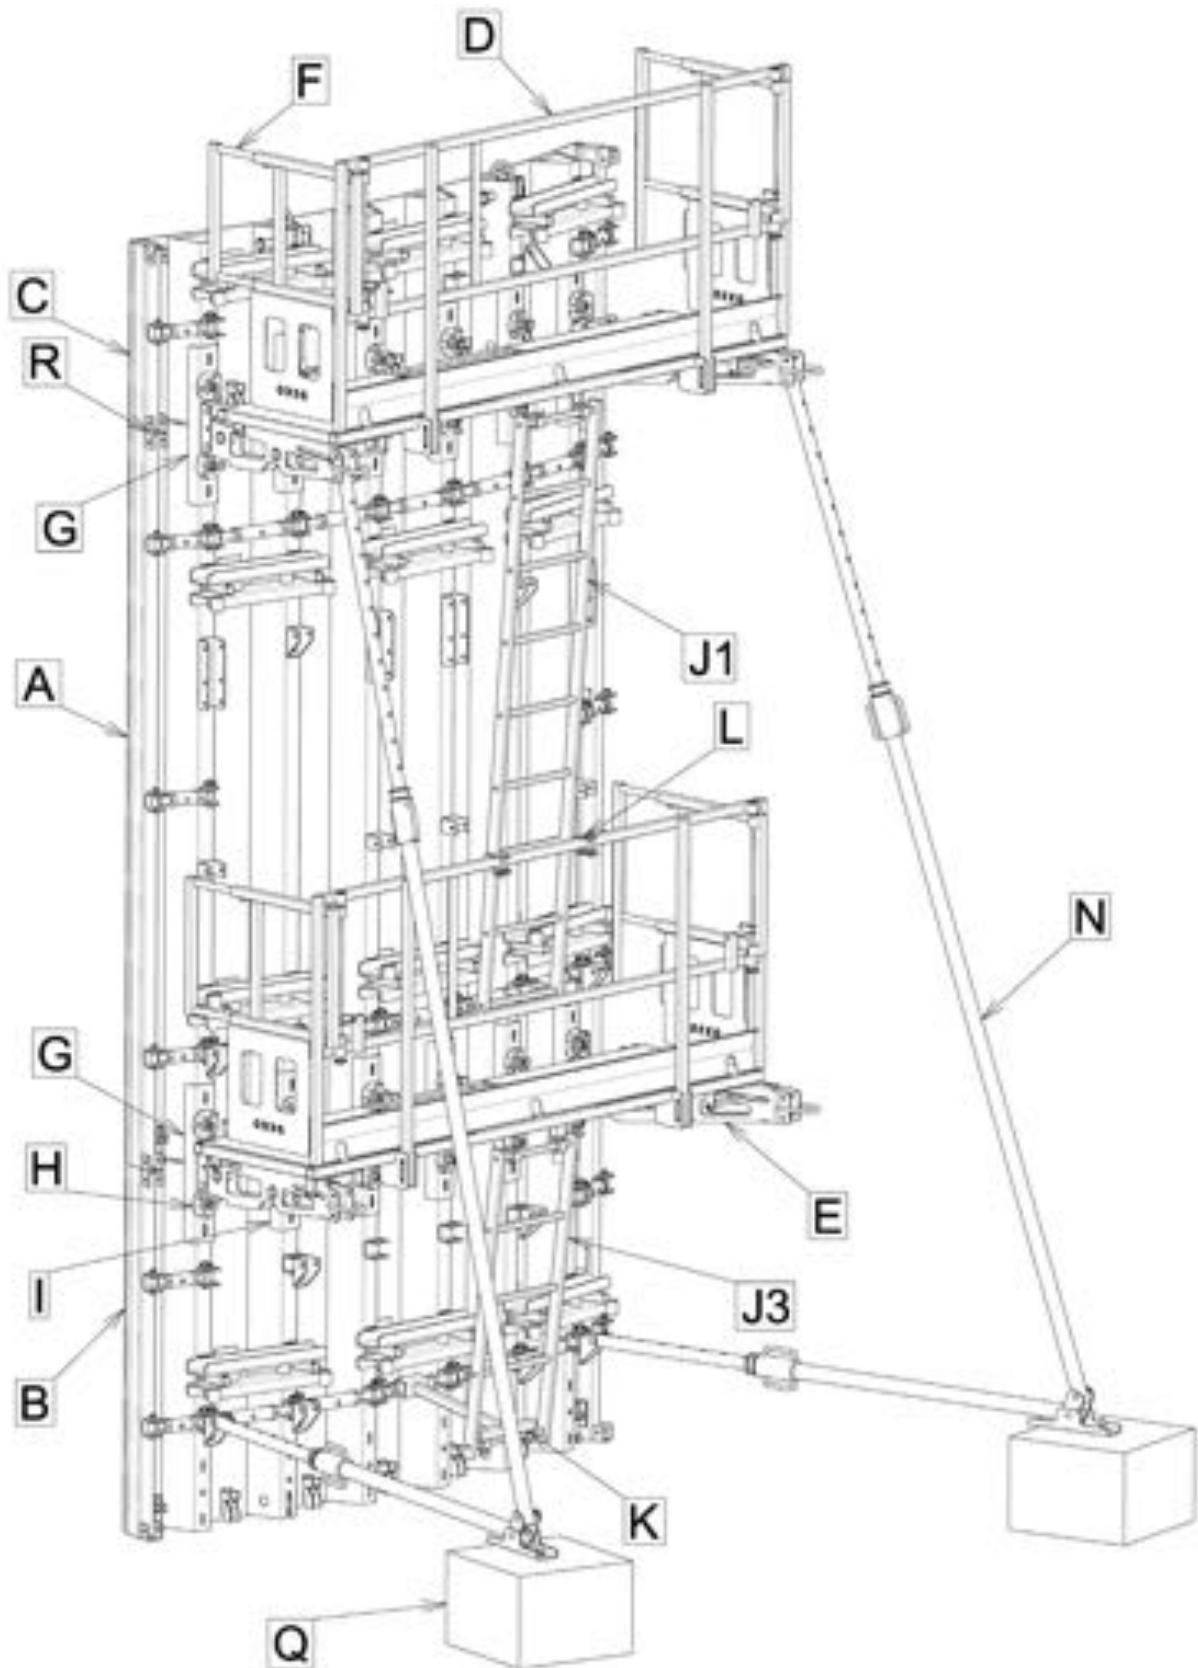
Assemblage d'une banche de 280 avec une sous-hausse de 140 et une réhausse de 70
